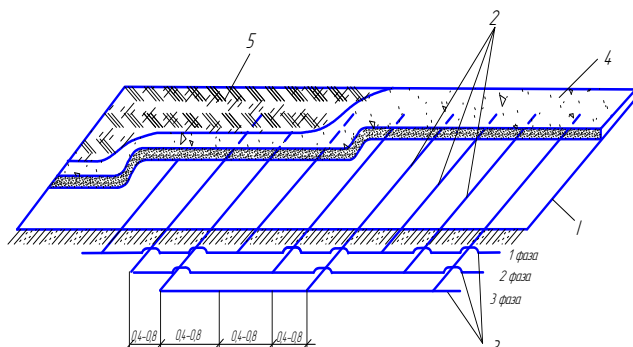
Схема отогрева грунта горизонтальными электродами: 1 – поверхность мерзлого грунта; 2 – электроды из арматурной стали  $d = 12–16$  мм; 3 – проводка каждой фазы; 4 – опилки, смоченные раствором соли; 5 – верхнее утепление (пленка, рубероид, щиты и т. д.)
